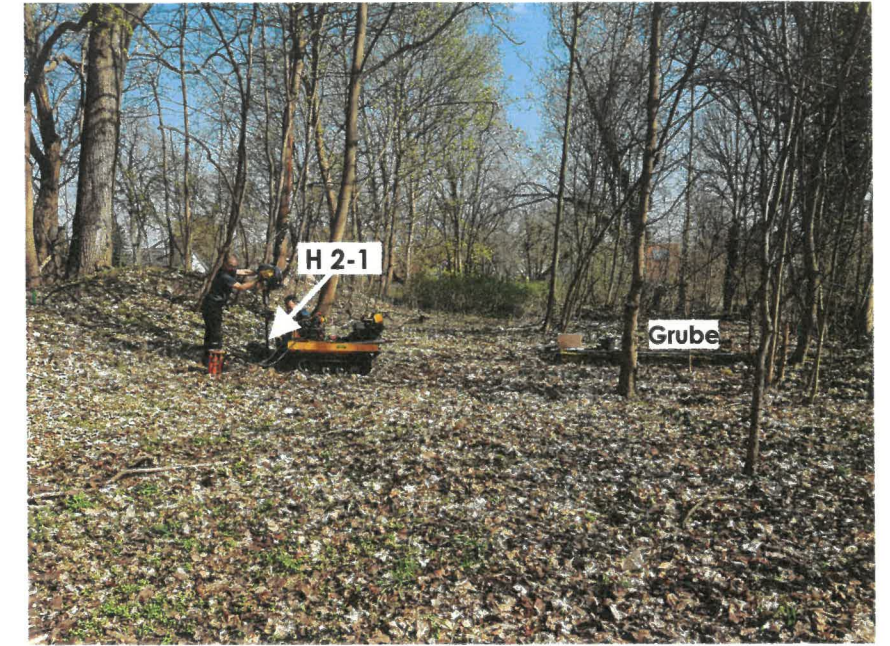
Blick in Richtung Osten auf die Position H 2-1 an der nordöstlichen Ecke des geplanten Hauses 2
